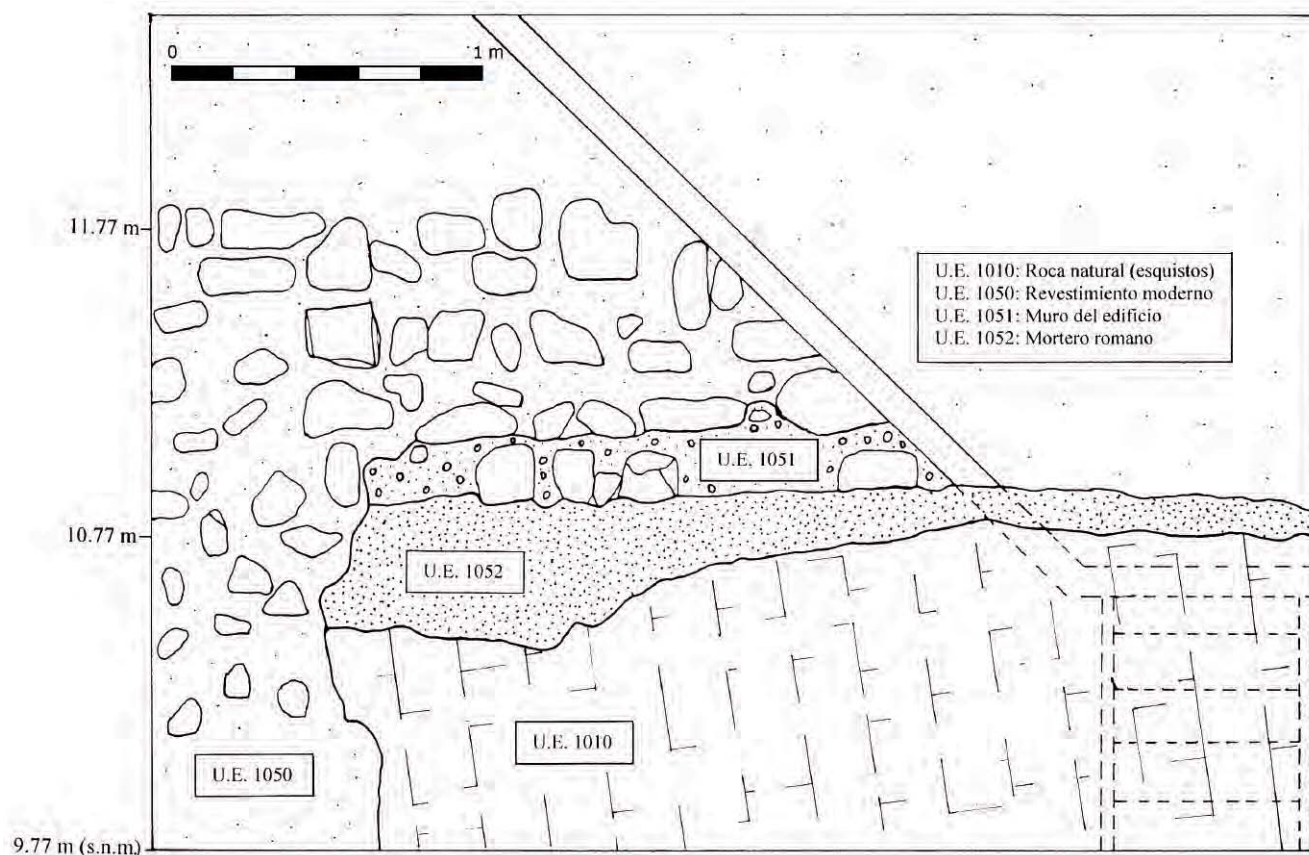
Alzado del muro este de la habitación de la planta inferior del antiguo Café-Bar La Catedral.
